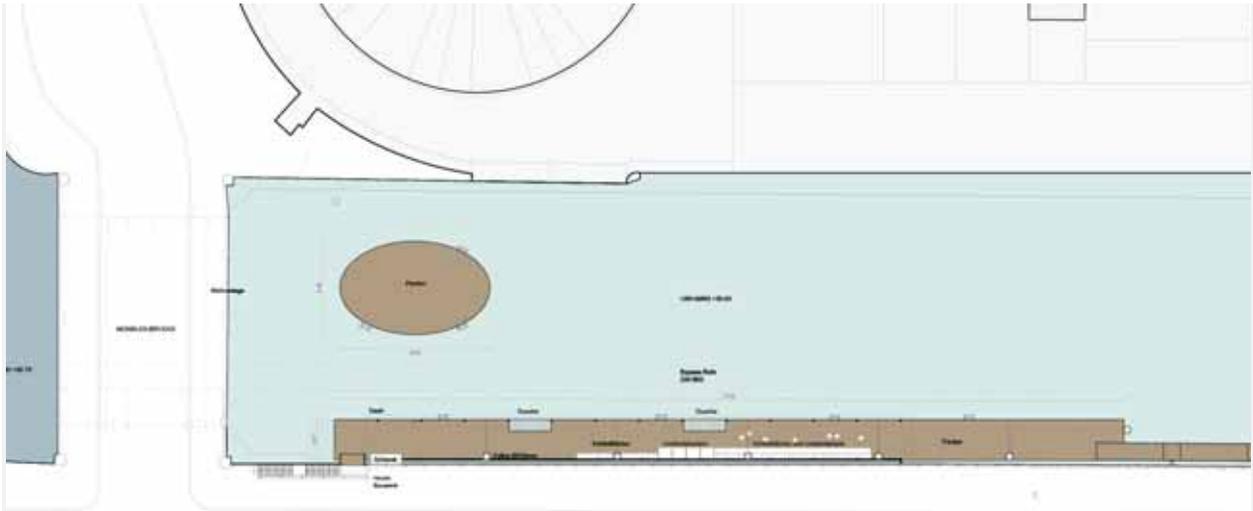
Grundriss "provisorischer" Wasserzugang Monbijoubrücke (LP_08_Monbijou_1_200.pdf)
